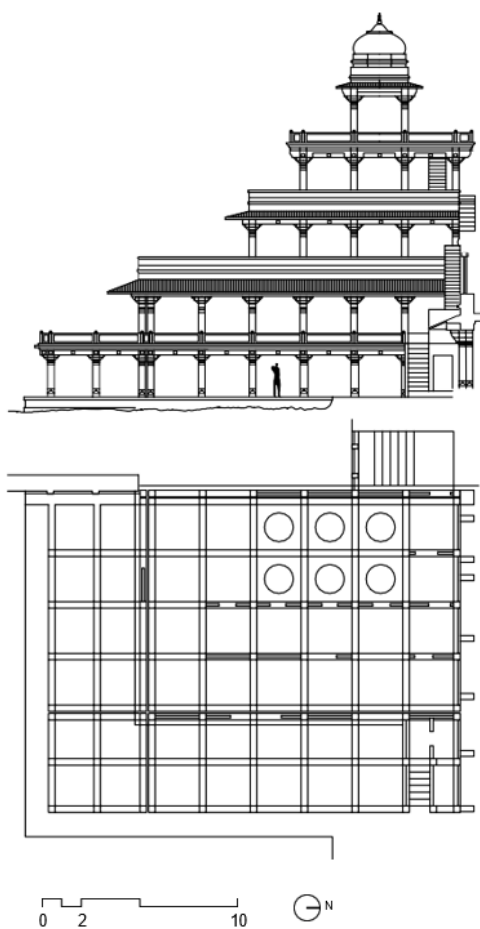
Planta y sección del Panch Mahal redibujado por los autores del artículo en base a medidas tomadas in situ.
